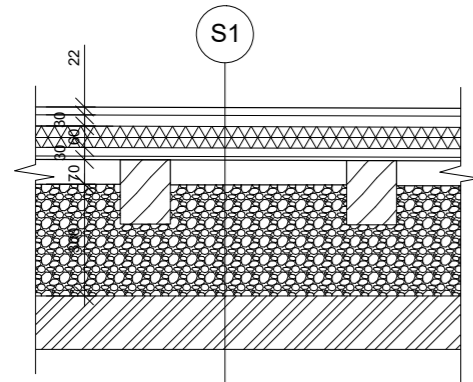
DETAIL PRAHU ZAHRADNÍCH DVEŘÍ ZÁMKU
